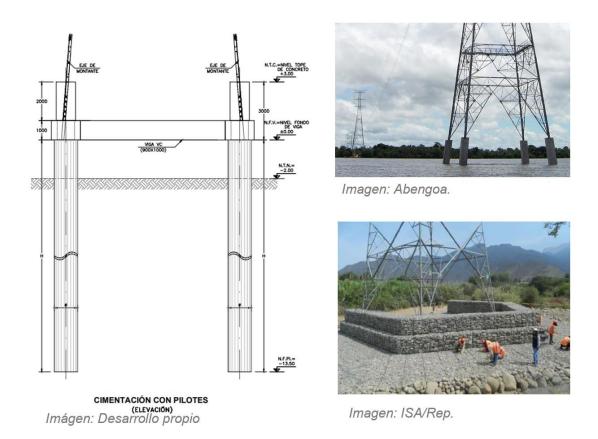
Estructuras sobre pilotes y obras de contención con gaviones
